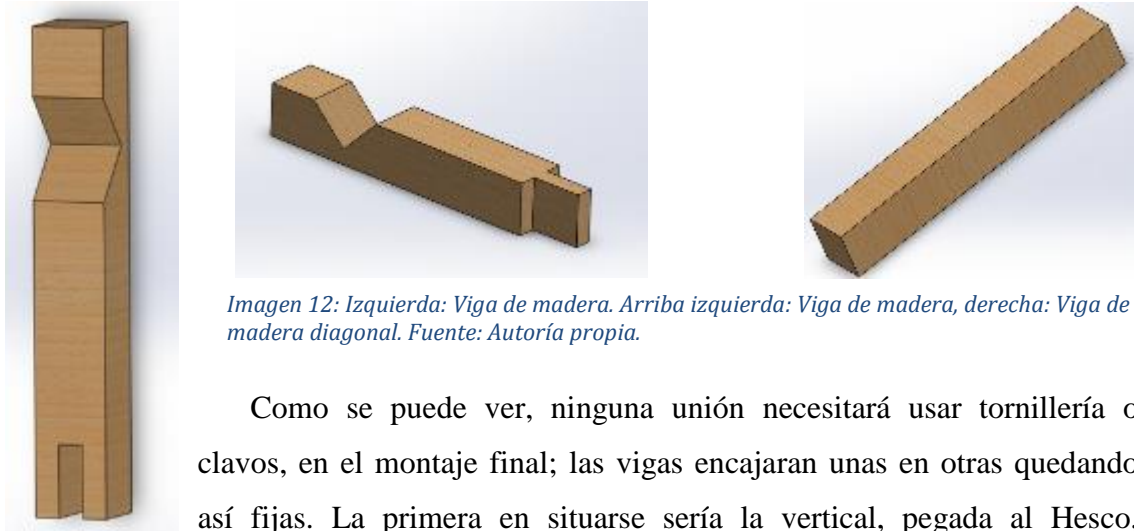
Izquierda: Viga de madera. Arriba izquierda: Viga de madera, derecha: Viga de madera diagonal. Fuente: Autoría propia.
